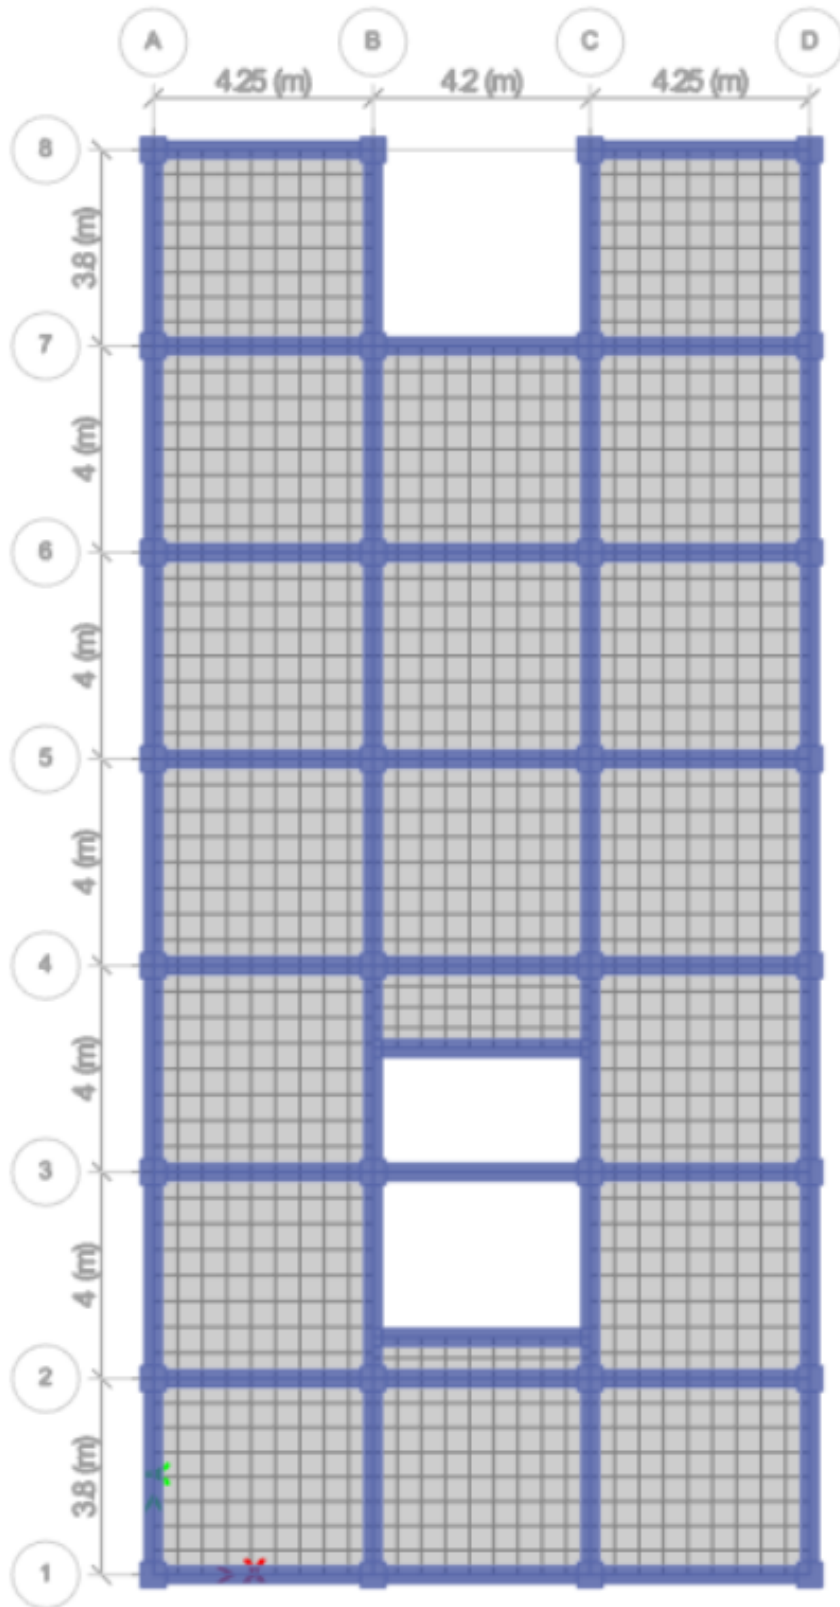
Modelado estructural de la edificación tipo (ET), vista en planta (Autores)
